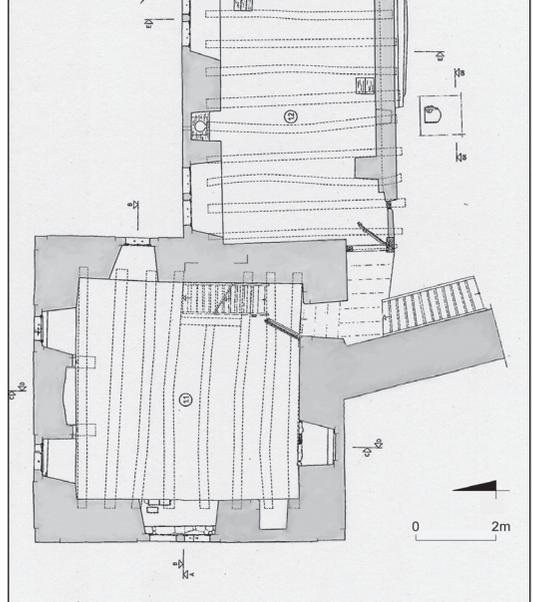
Grundriss des ersten Obergeschosses (M. Suck, C. S. Prinzhorn 2001).
